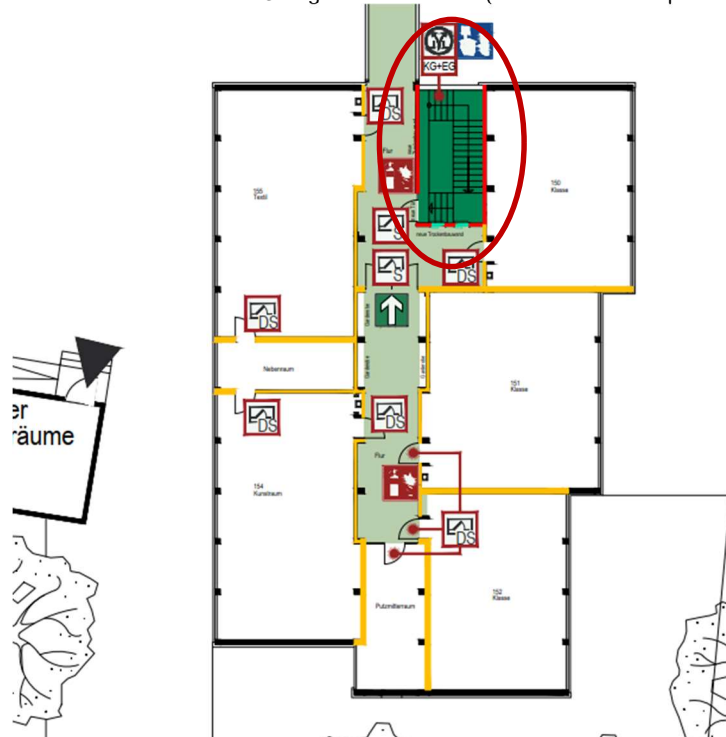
Planausschnitt Erdgeschoss (Brandschutzkonzept vom 02.11.22)
